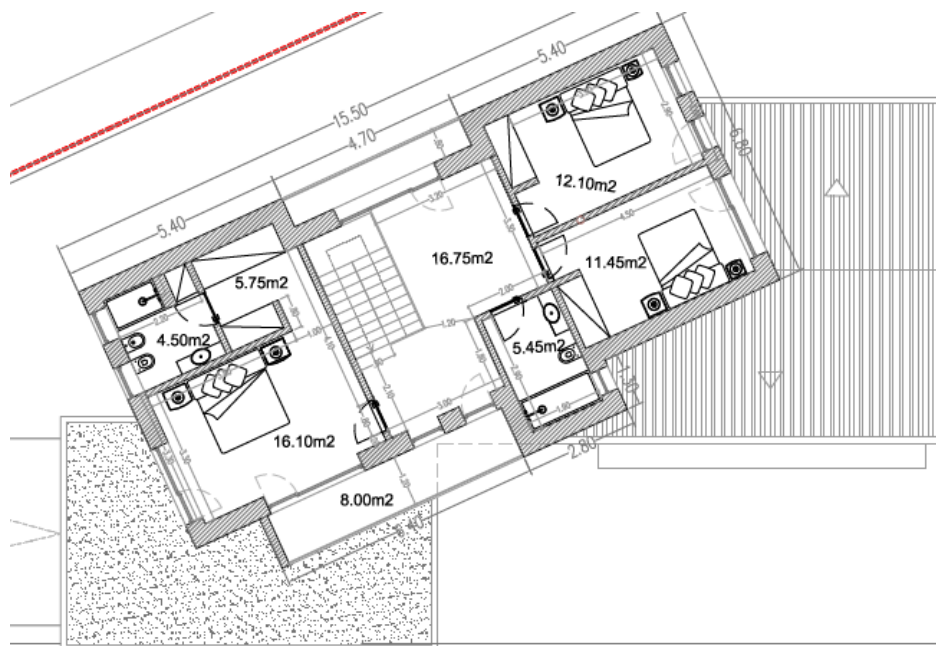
Planta do edifício – estudo caso 3, Piso 1
